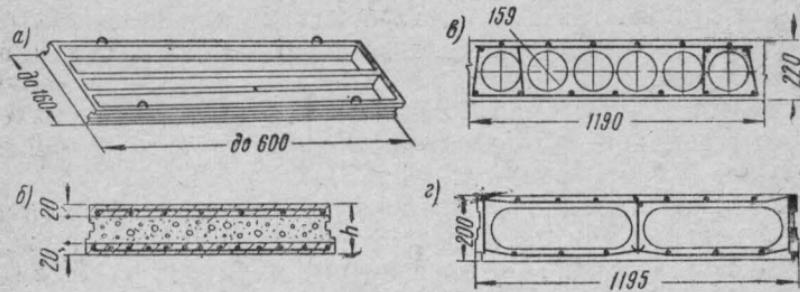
Перекрытия с настилами из элементов весом до 1,5—2 т
